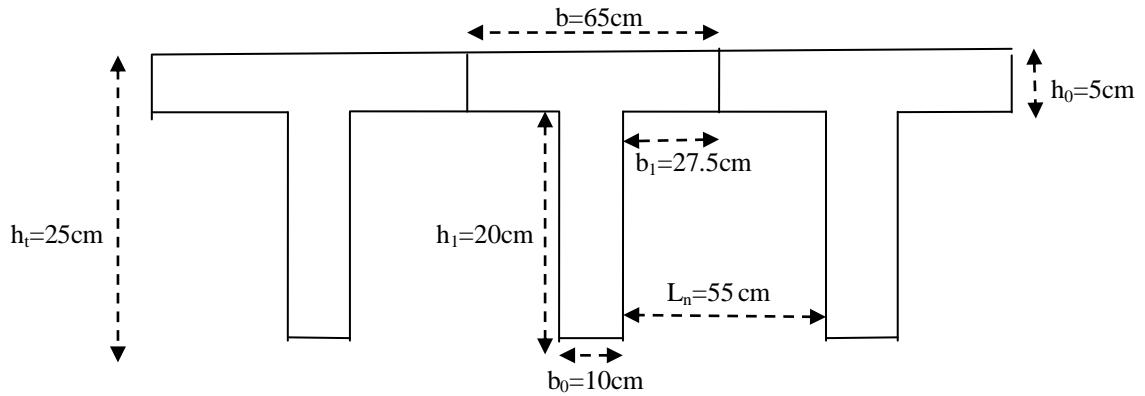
Coupe transversal d'un plancher Corps creux
